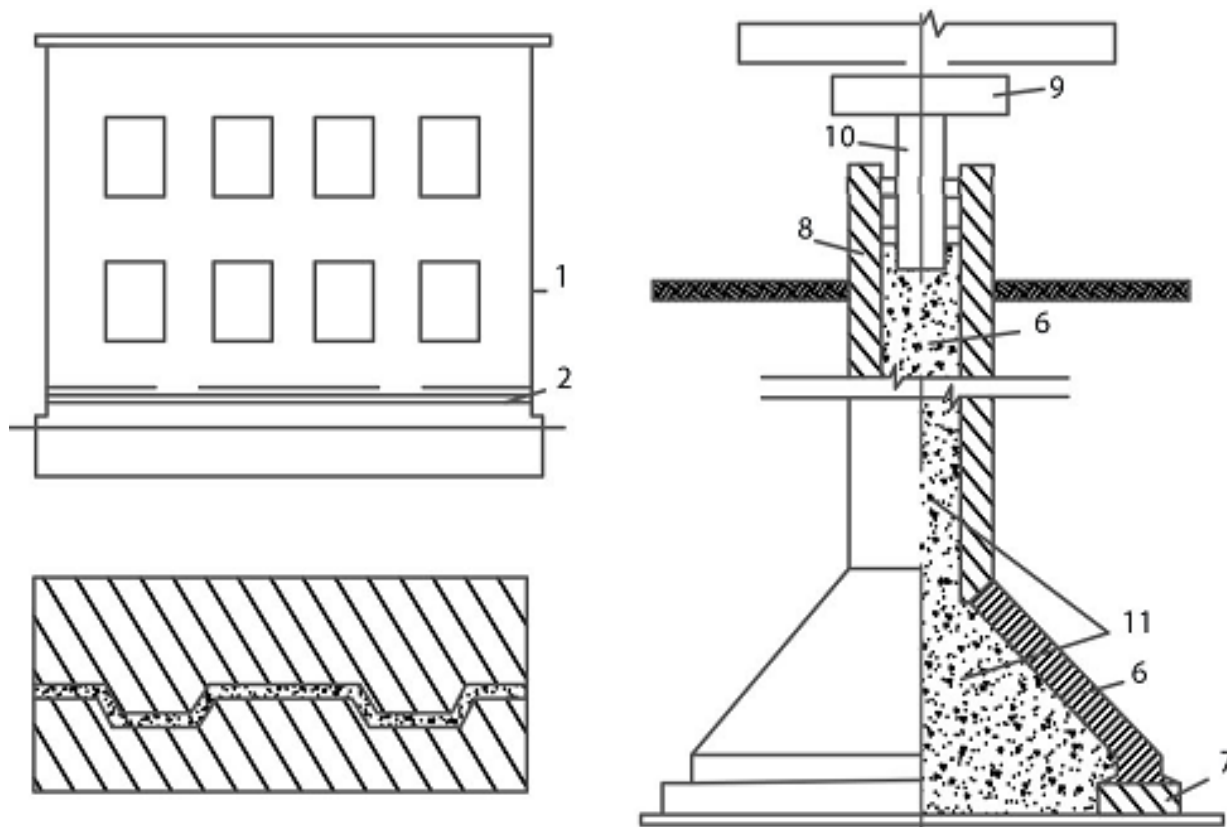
Конструкции сейсмоизолирующих фундаментов:
